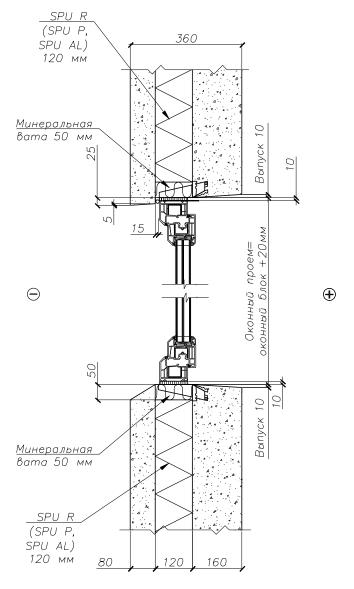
Разрез рассчитываемой конструкции стены в зоне расположения оконного блока
